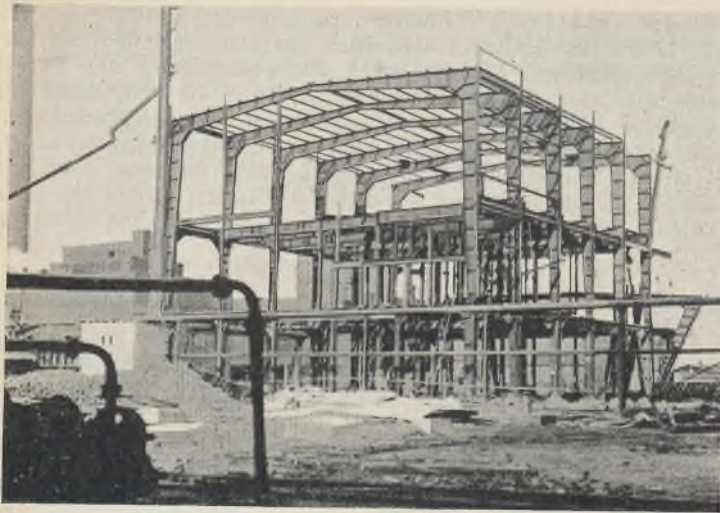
Geschweißte mehrstöckige Vollwandrahmen;
